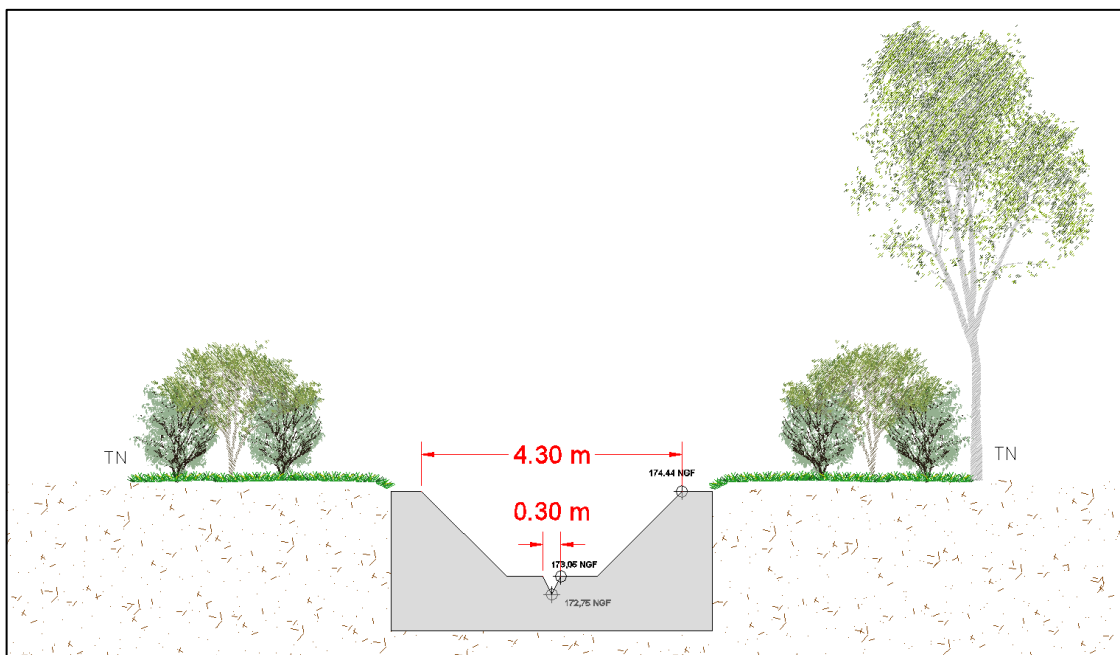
Coupe en travers de la nouvelle prise d'eau du plan d'eau
